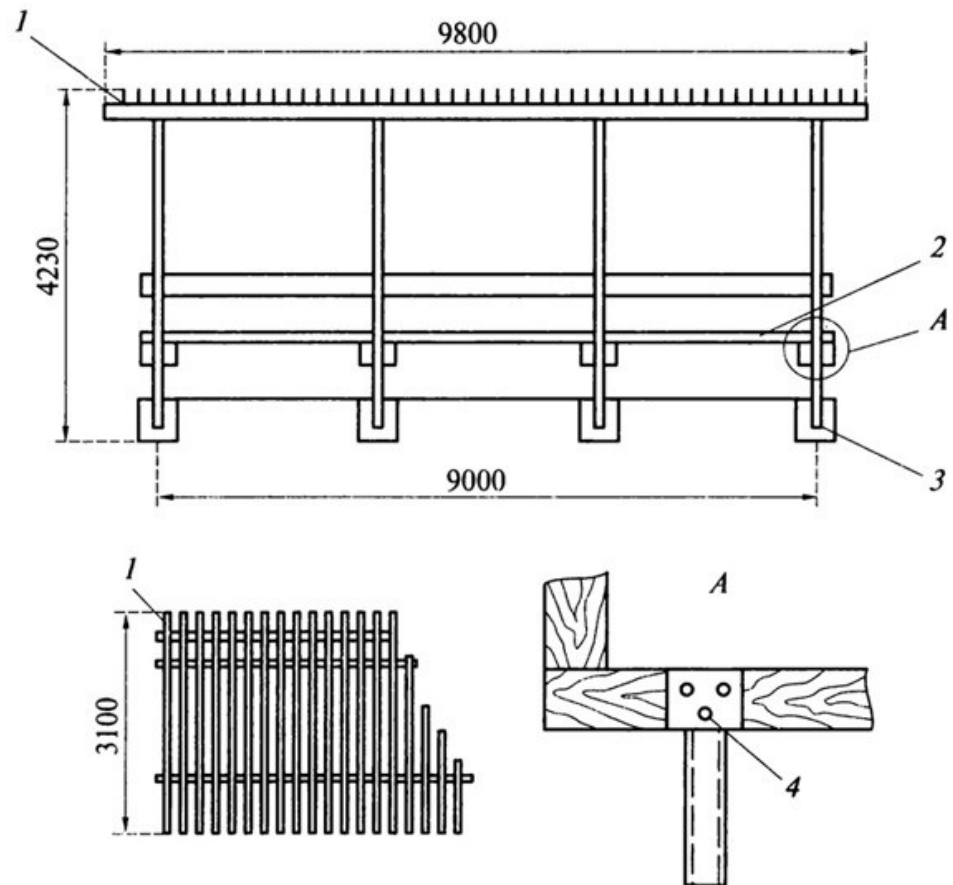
Схема простейшего трельяжа: 1 — кровля; 2 — скамья; 3 — «стакан»; 4 — болт; А — деталь крепления
